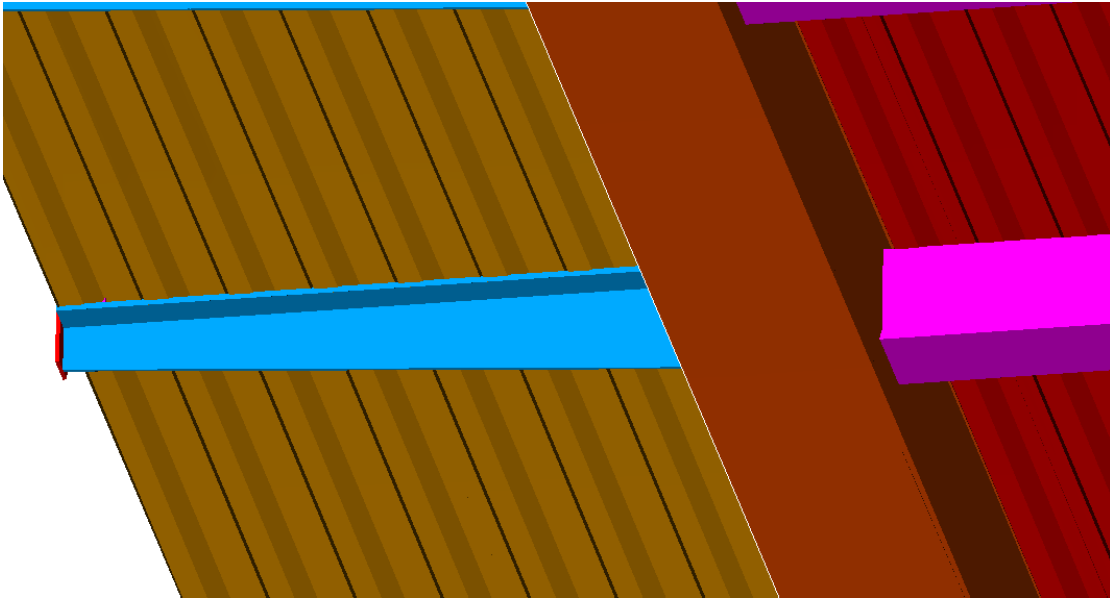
Viga cambio inercia en voladizo soportando forjado colaborante acera
